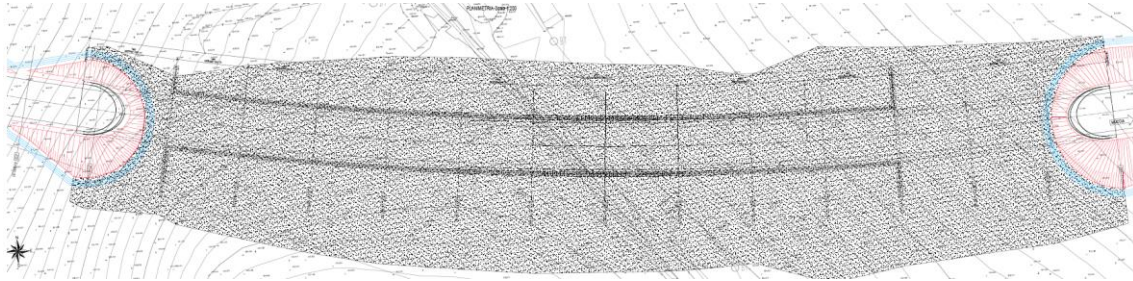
Galleria Artificiale Mistranello - Stralcio Planimetrico
